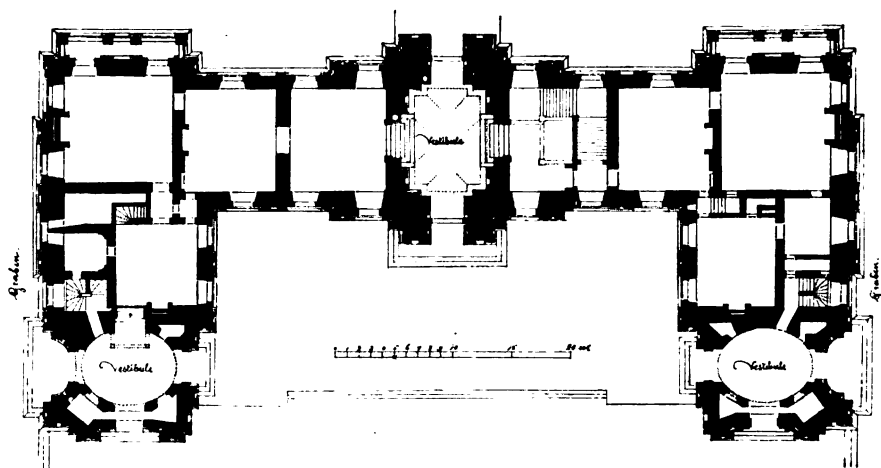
Schloss de Maisons. Grundriss (n. Sauvageot).
